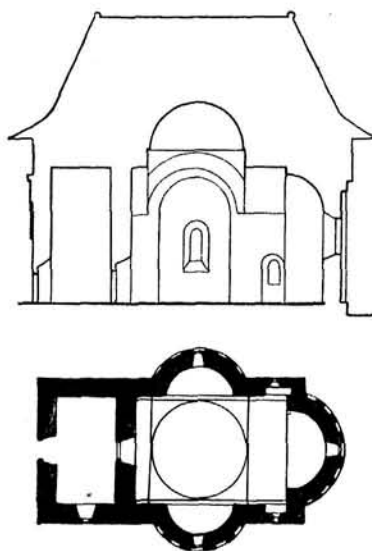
Eglise de la Sainte Trinité de Sireth. Coupe et plan.
